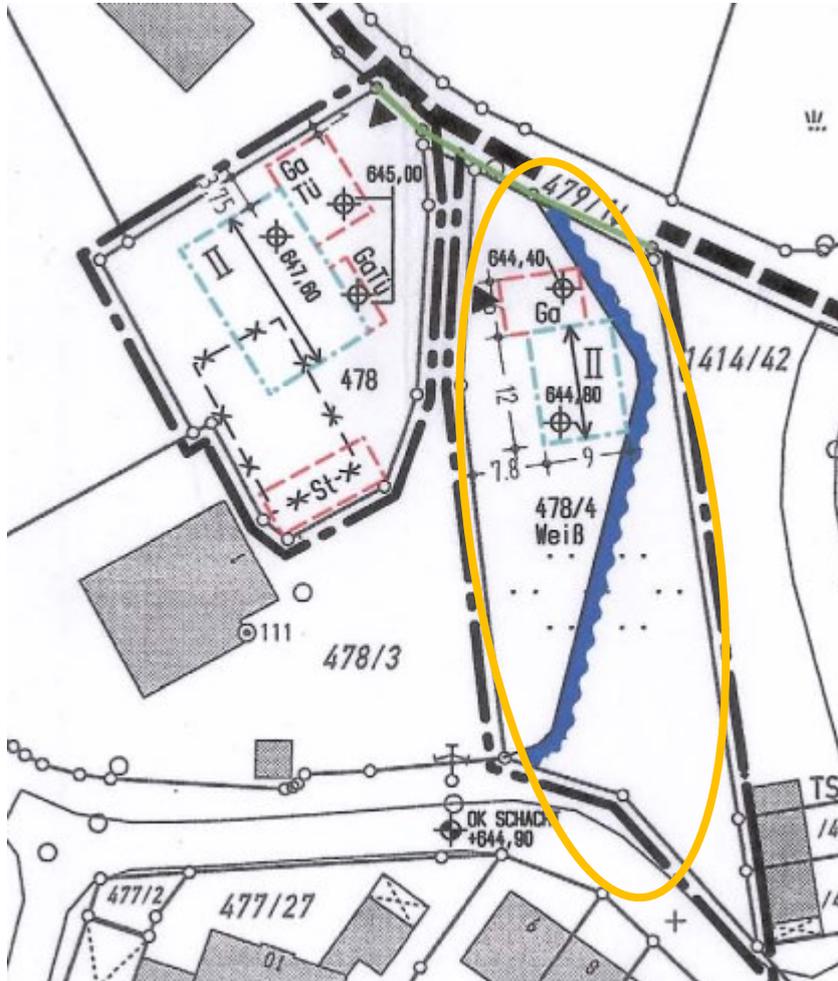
Auszug 6. Änderung Bebauungsplan Bibelöd mit Änderungsbereich
